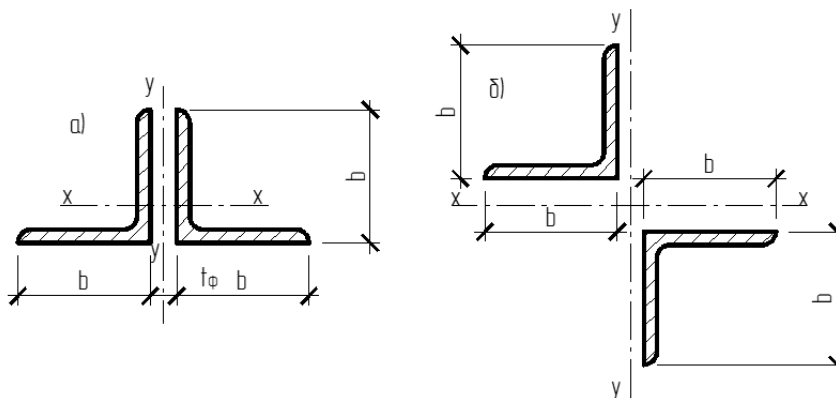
Сечения элементов легких ферм – равнополочные уголки (б – стержень 6, 7; а – остальные стержни фермы)
